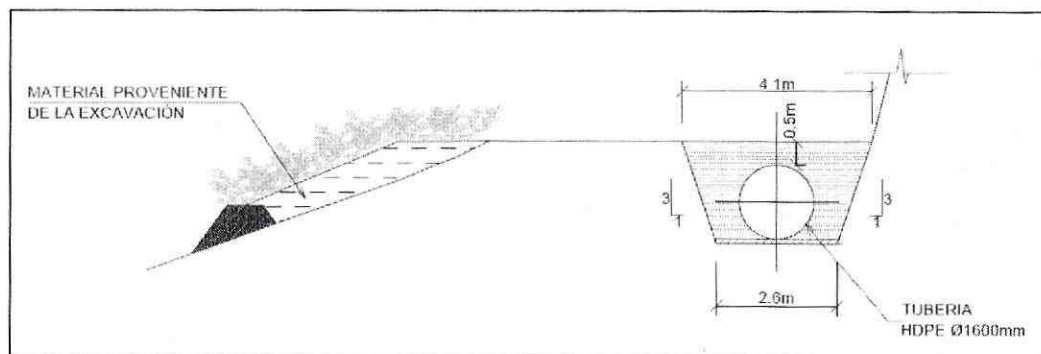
Esquema de revegetación de laderas con material de excavación.
